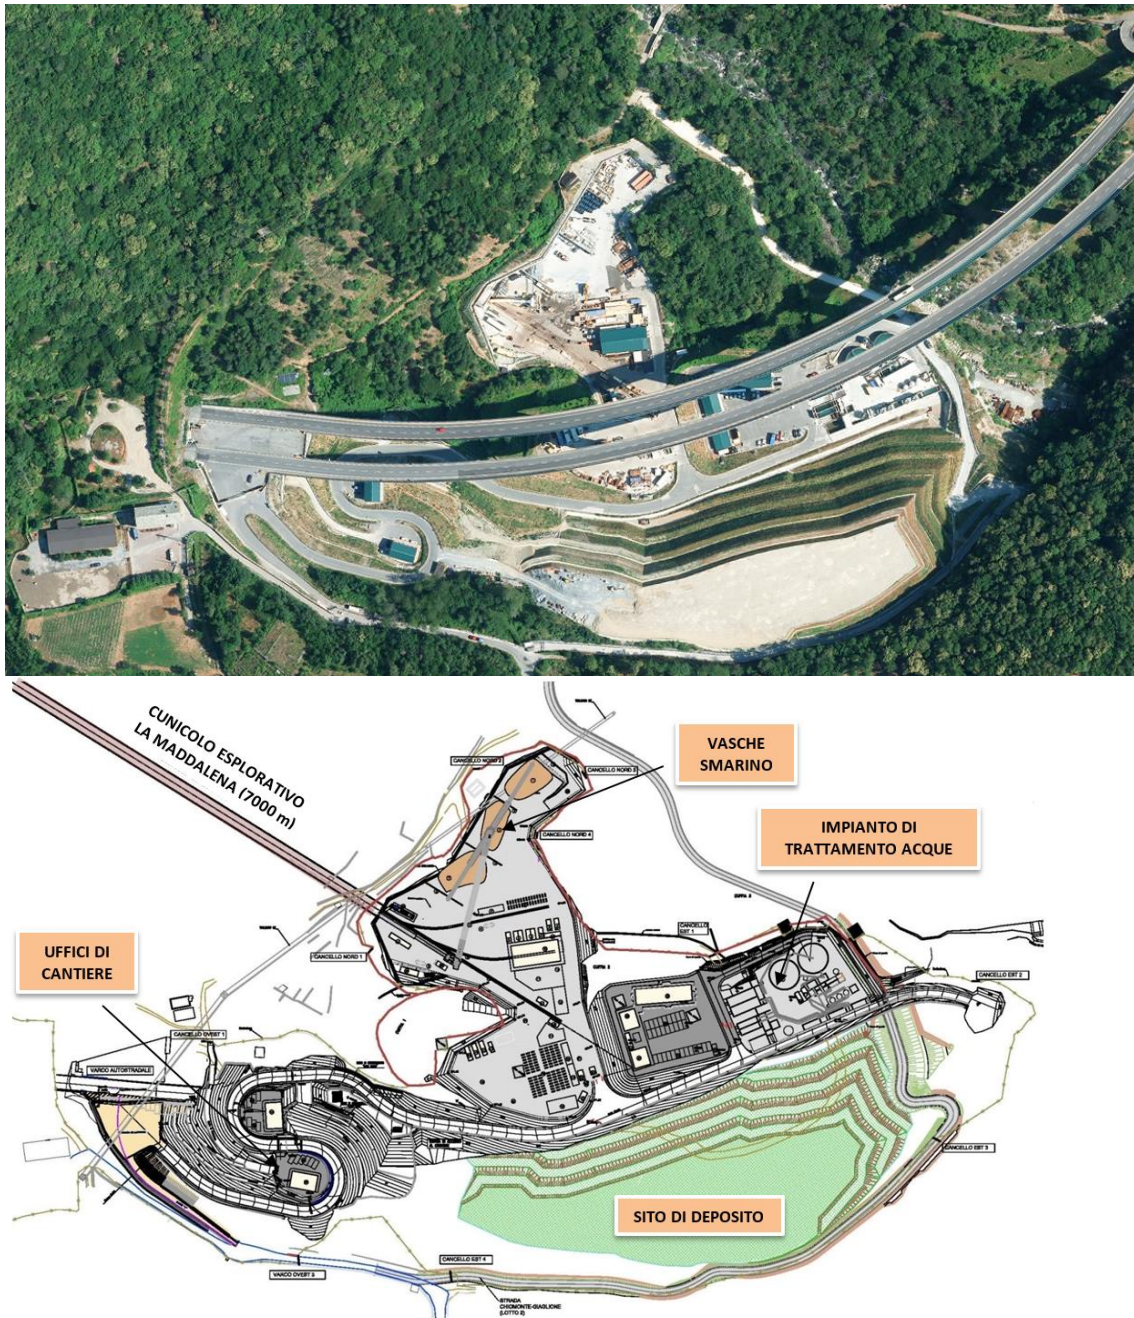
Cantiere del cunicolo esplorativo La Maddalena: ortofoto scattata nel 2017 e stralcio planimetrico.
